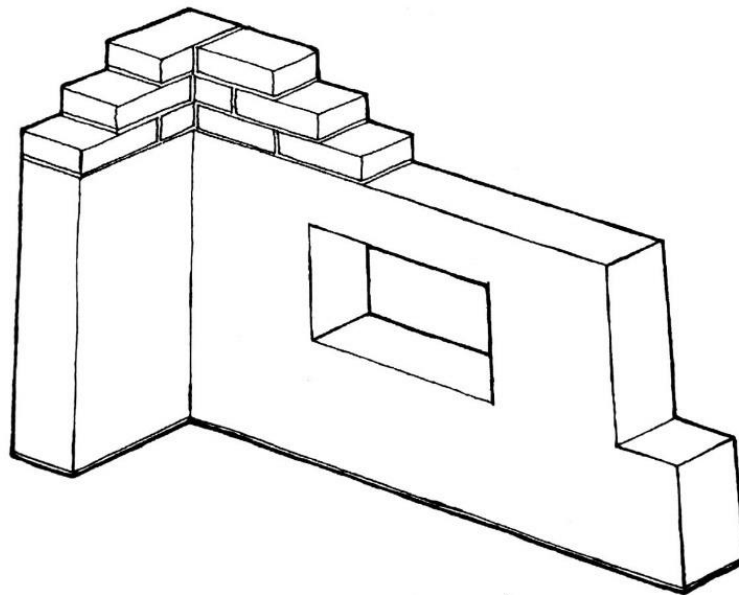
Esquema estructural de muros de adobe o tapia pisada. Adaptado de Maldonado Rondón y Chío Cho (2007). Visión estructural de las edificaciones de la ciudad de Bucaramanga.
